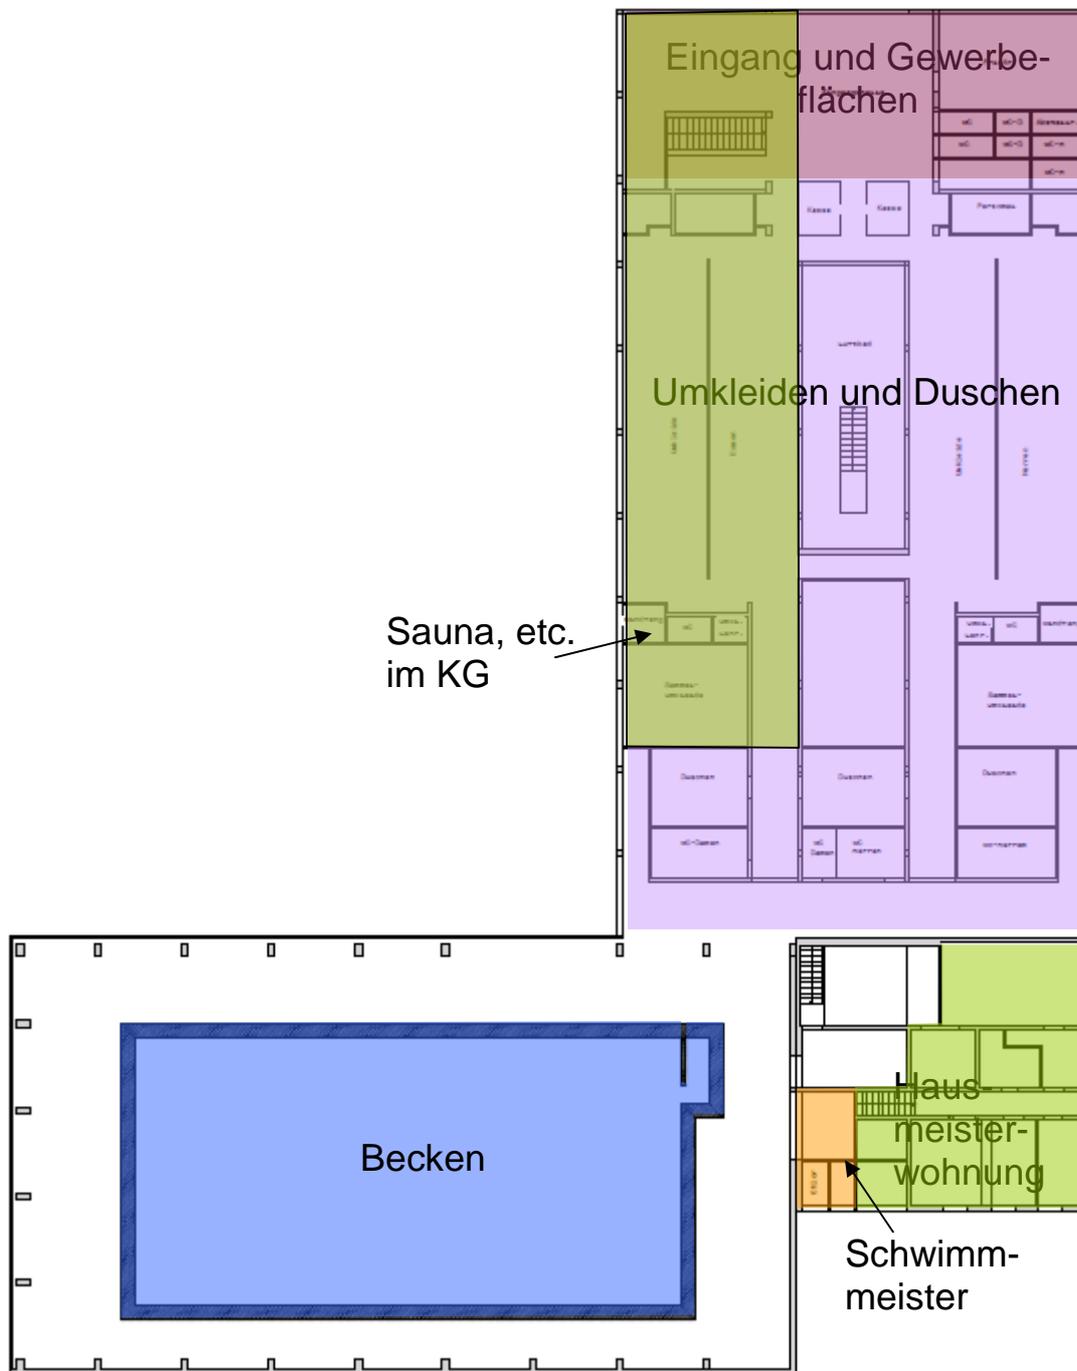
Grundrisschema zur Nomenklatur der Gebäudenutzungsflächen
